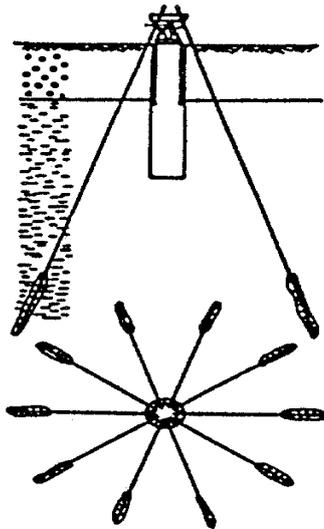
Probelastung durch Belastungskrone und Erdanker
